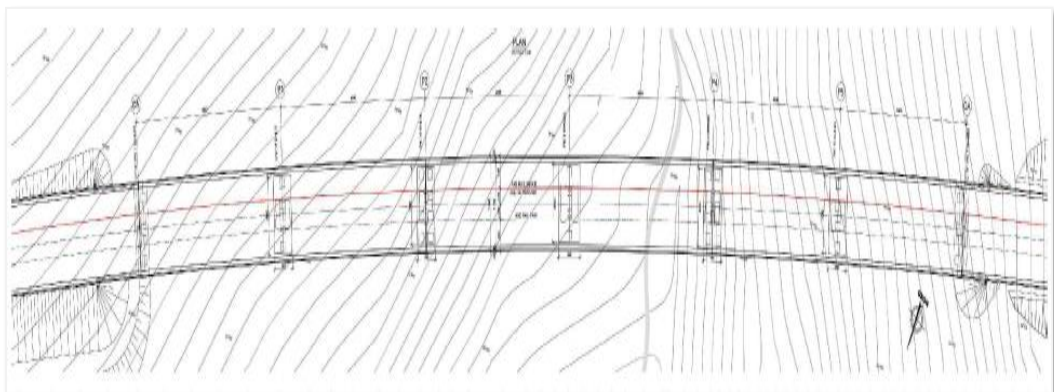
Vue en plan de l'ouvrage en béton armé
